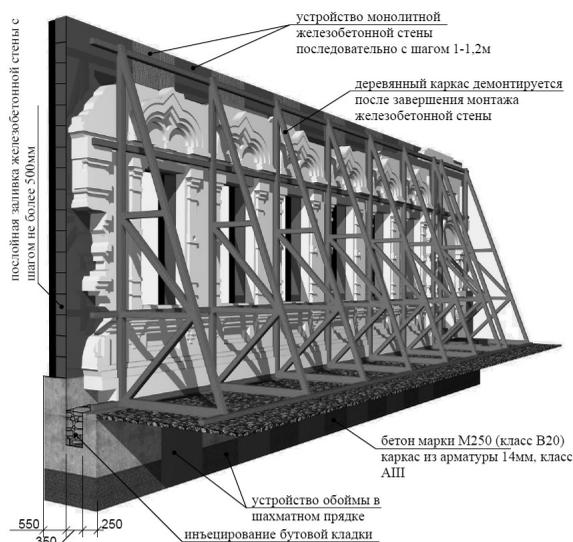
Схема устройства: подпорной деревянной конструкции со стороны улицы; железобетонной обоймы усиления фундамента и монолитной стенки главного фасада
